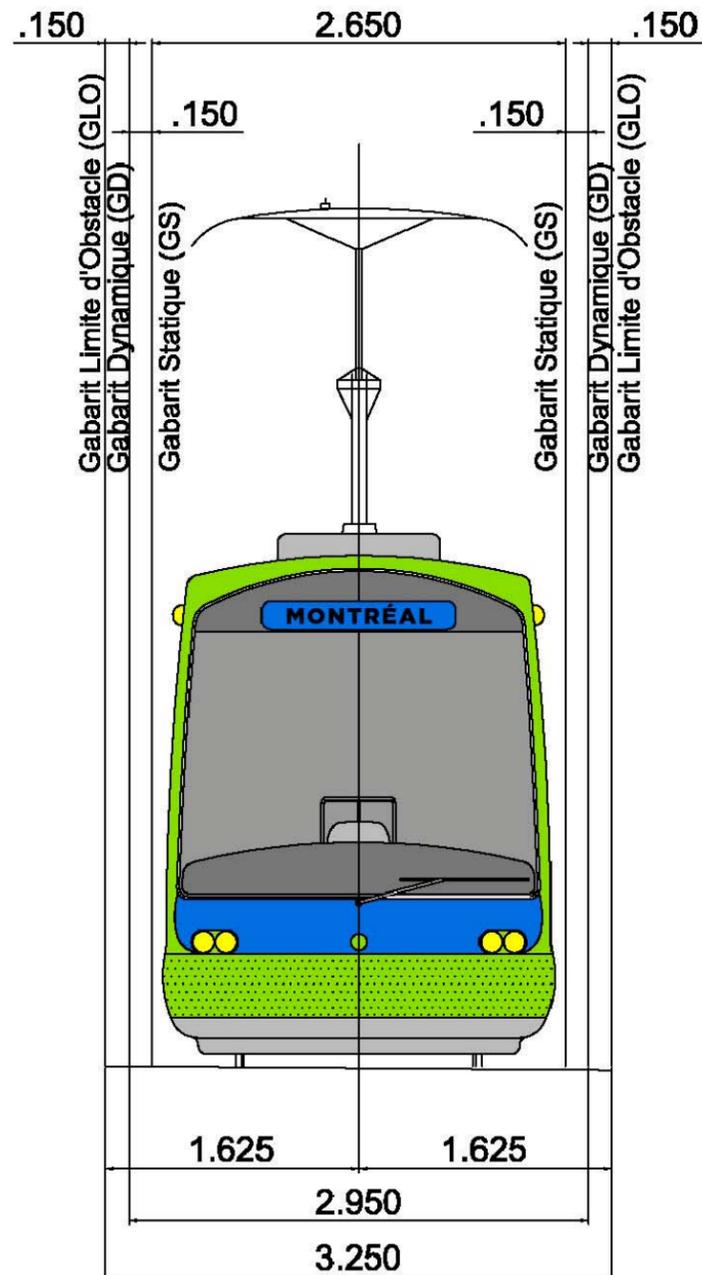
GLO en voie double – Alignement droit sans poteaux centraux
